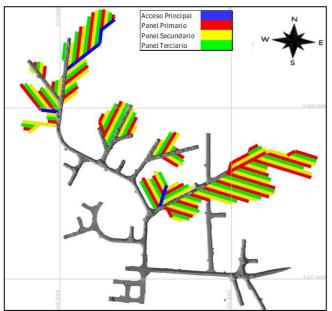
Vista en Planta (Top Cut) – NV4720. UM San Gabriel – Buenaventura Fuente: Elaboración propia
